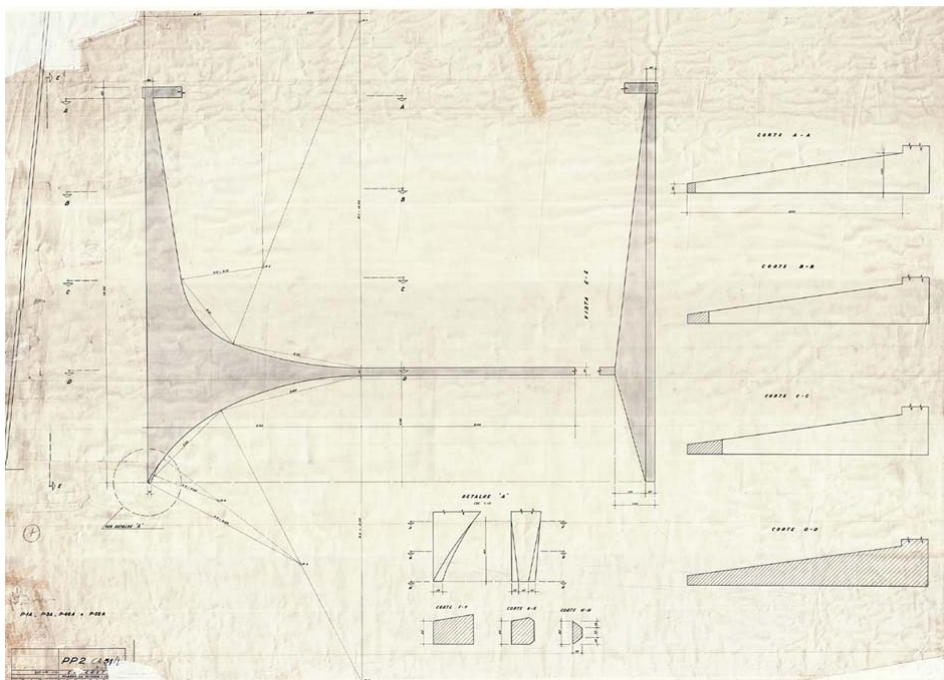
Palácio do Planalto, 1957-1958. Oscar Niemeyer, Arquitetura. Joaquim Cardozo, Cálculo Estrutural.
